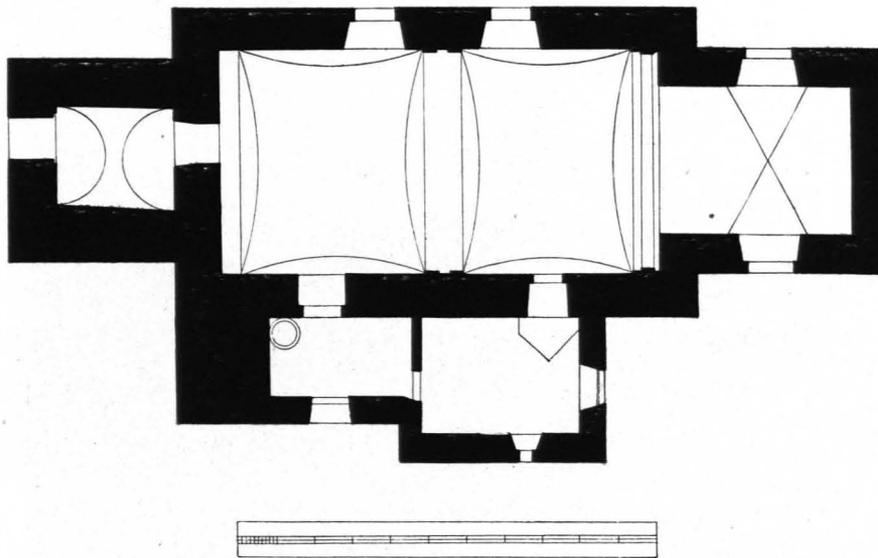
Ober-Nondorf, Filialkirche, Grundriß 1 : 200 (S. 363)
